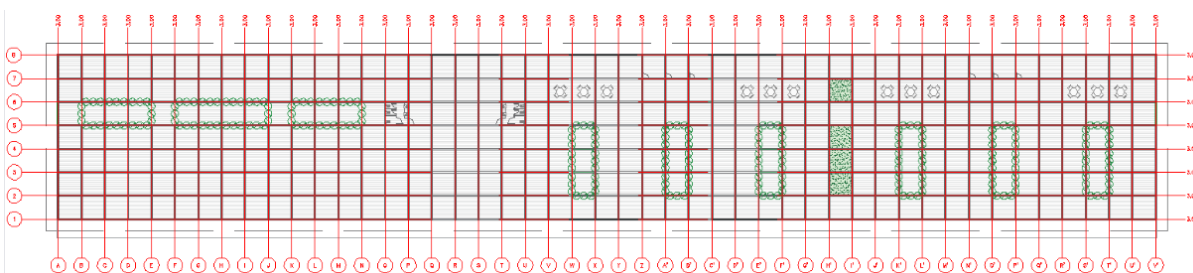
Planta baixa Setor 01, livre de escala. A autora, 2023.
